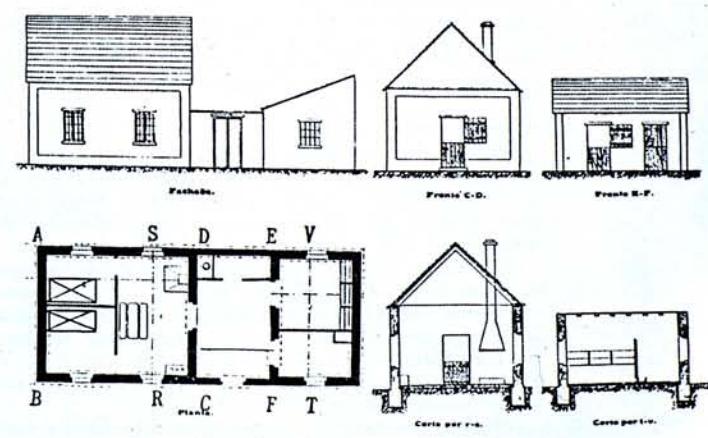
Casa para colonos en la Algaida. Planos y alzados.
